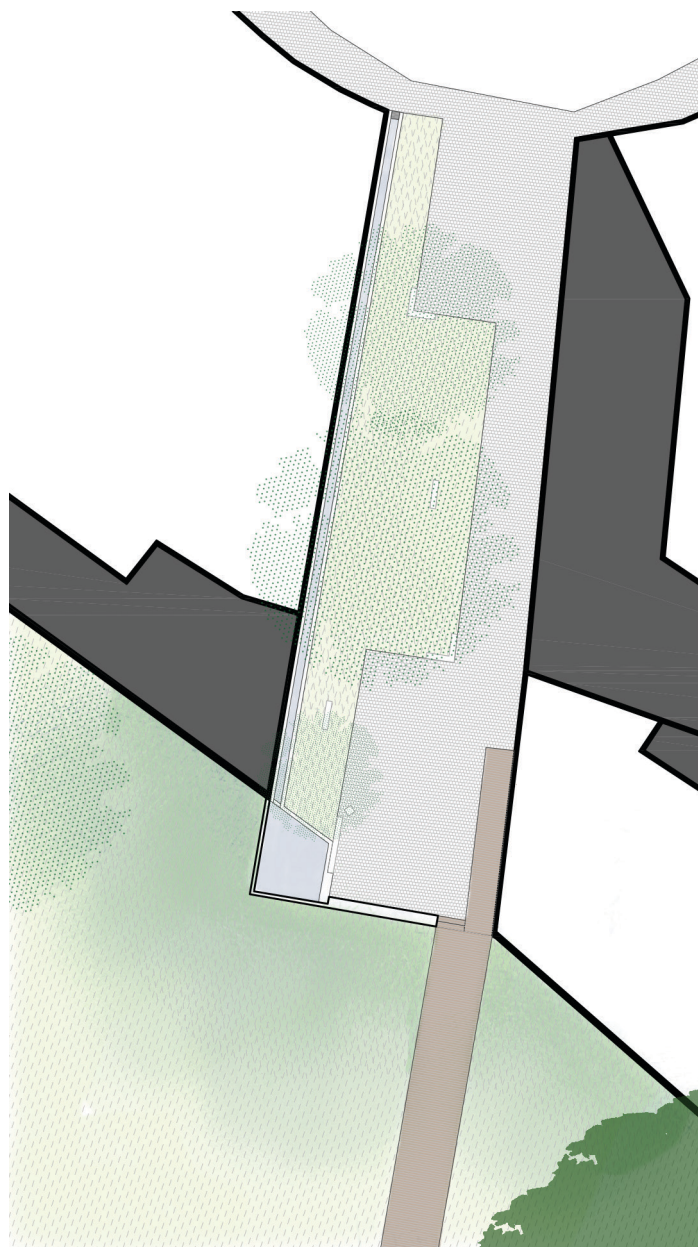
Planta da entrada do parque na Travessa da Fonte.
